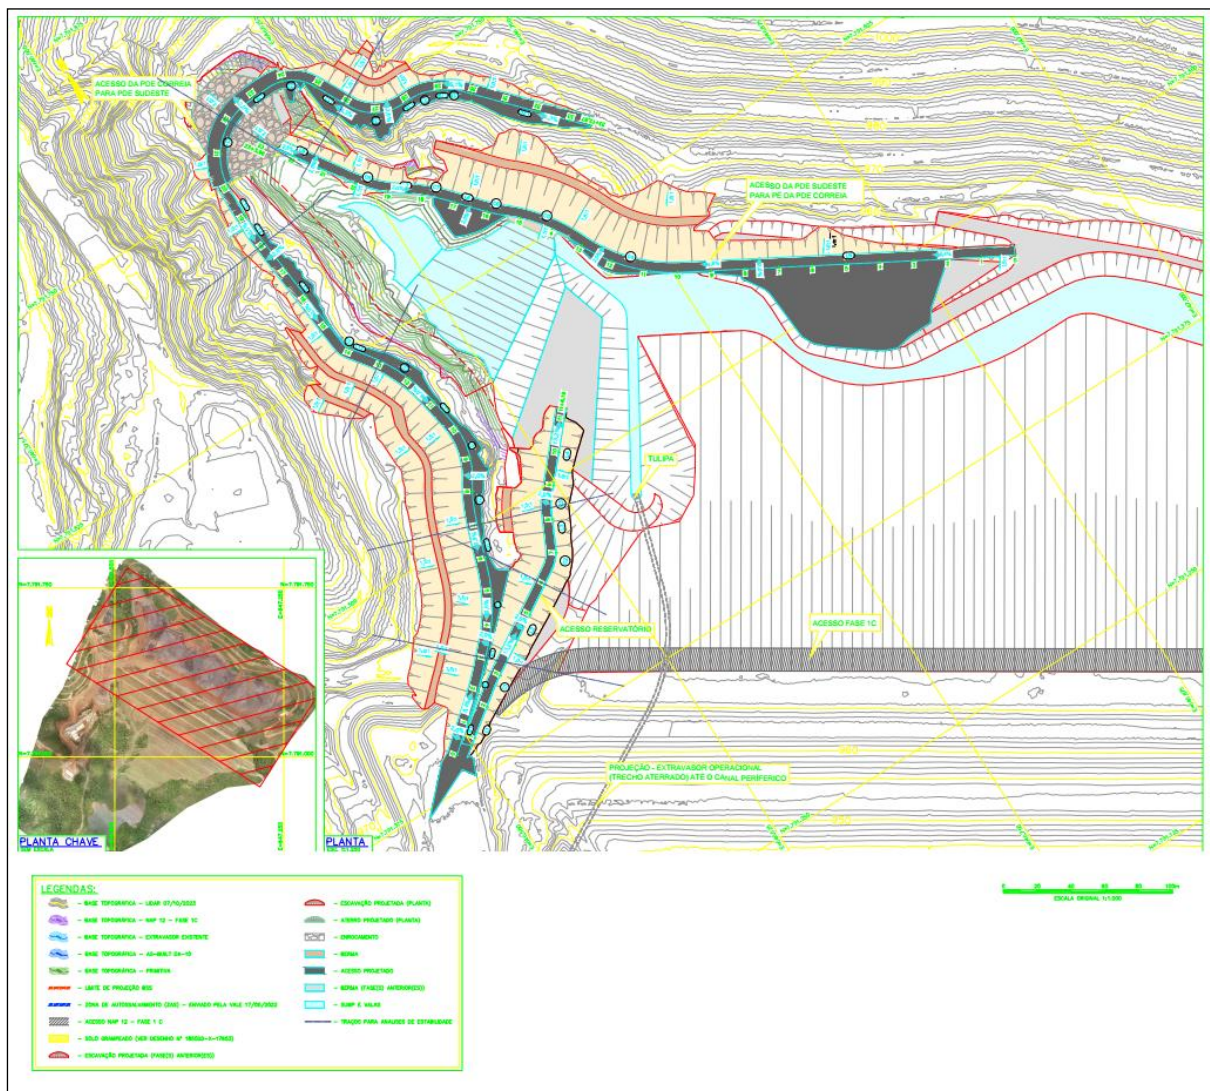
Layout do acesso em área adjacente à PDE Correia.
